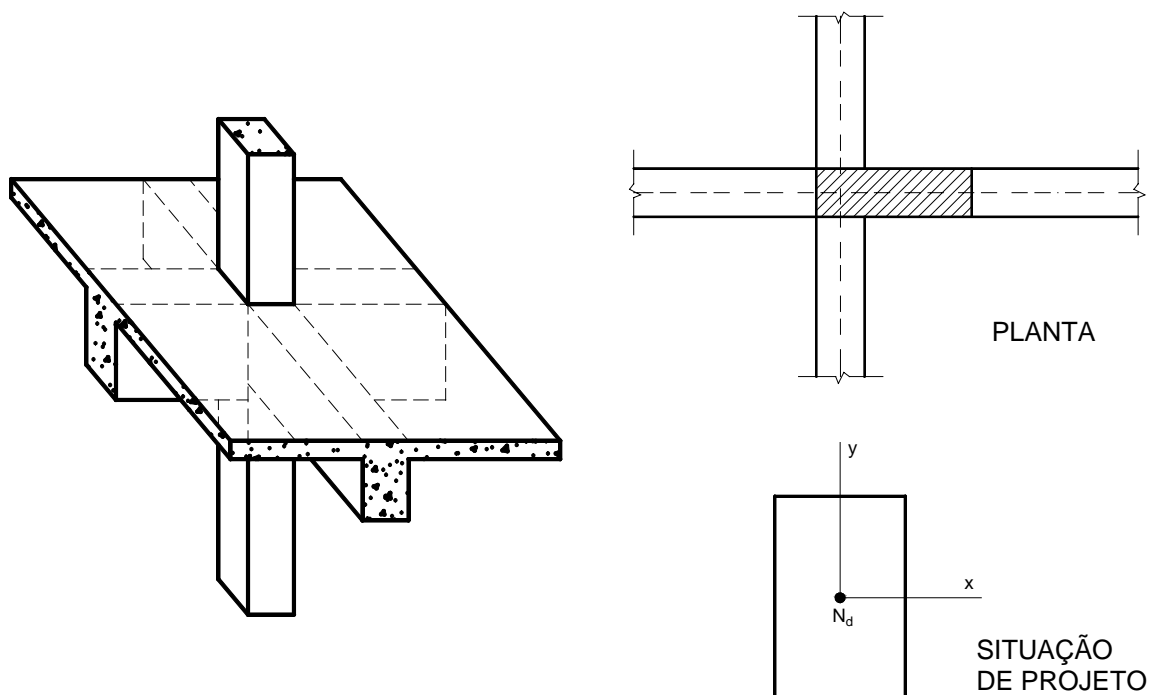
Arranjo estrutural e situação de projeto dos pilares intermediários.
